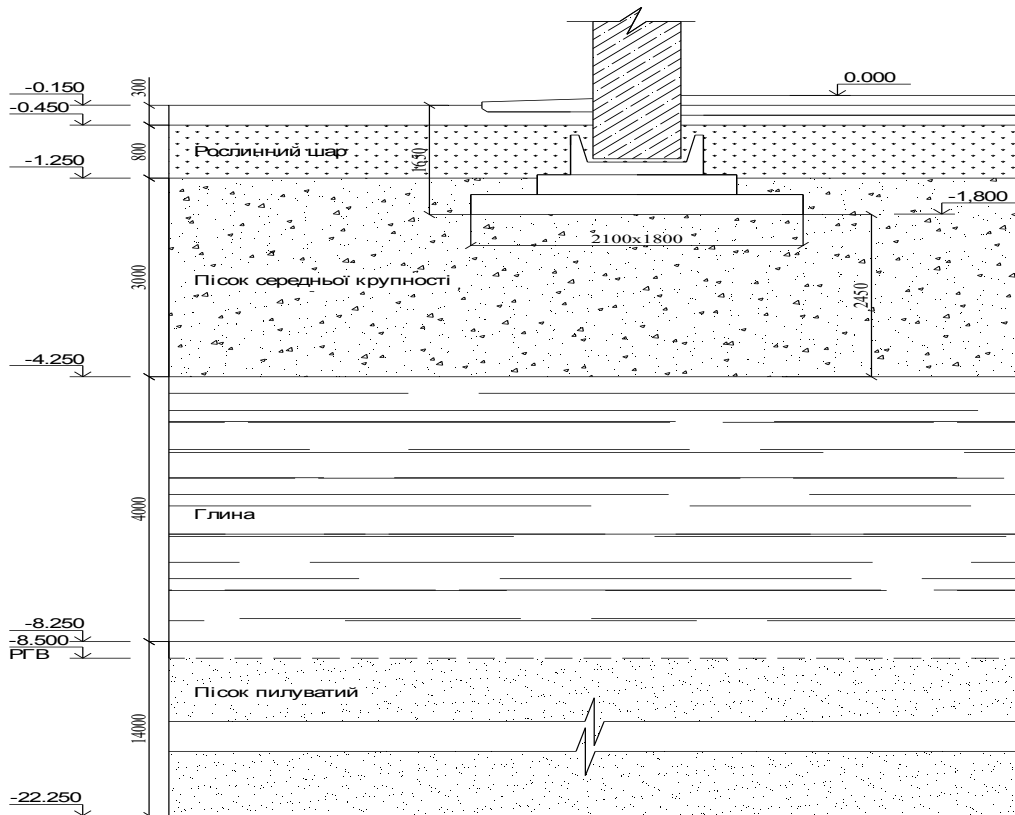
Геологічний розріз із існуючим фундаментом мілкого залягання
